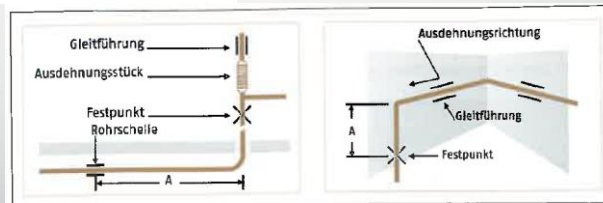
Anordnung von Gleit- und Festpunktschellen unter Berücksichtigung der Wärmeausdehnung bei Deckendurchführungen und Umführungen (DKI – Die fachgerechte Kupferrohrinstallation)
